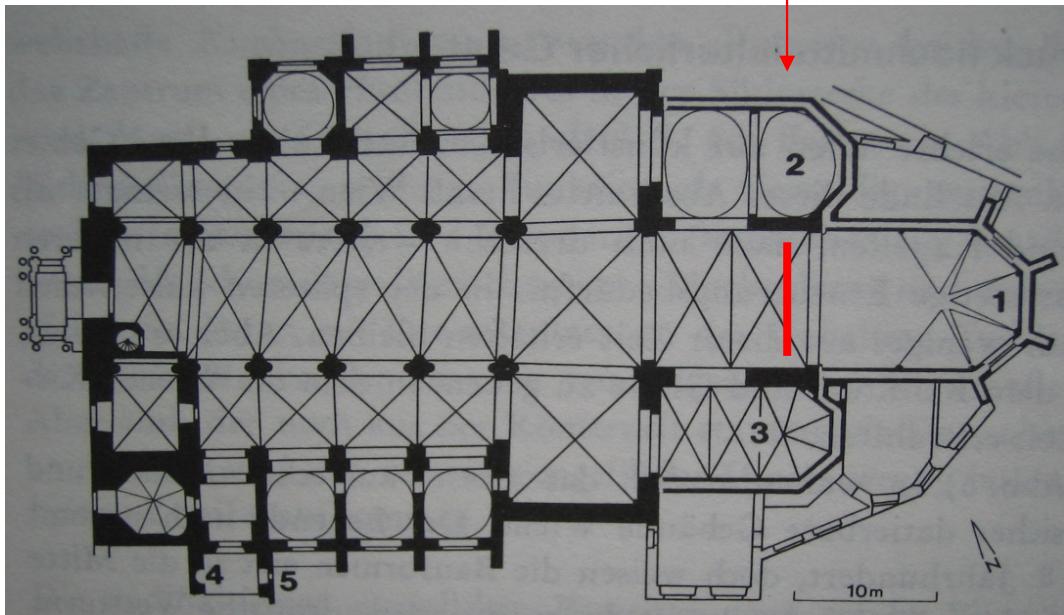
Wien, St. Michael, Verortung im Grundriss
